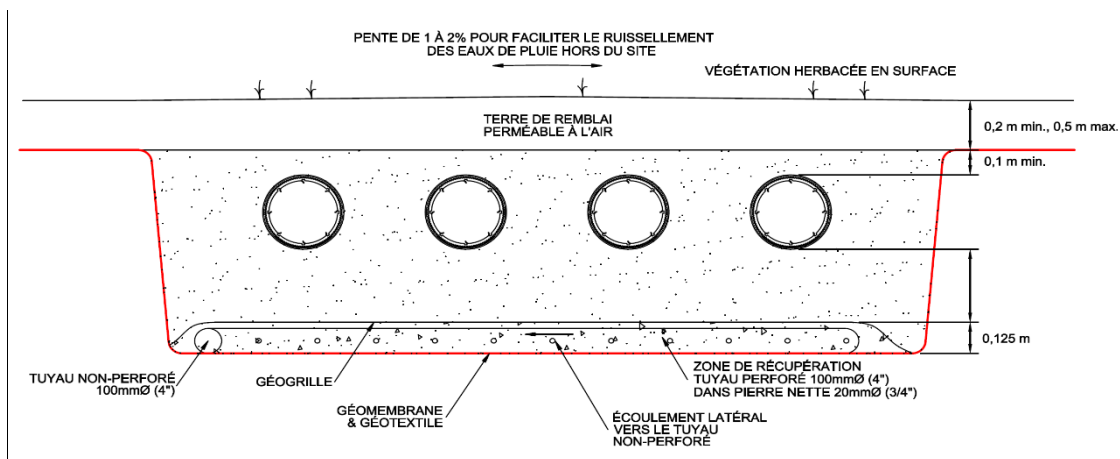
Vue en coupe d'un System O)) avec zone de collecte
